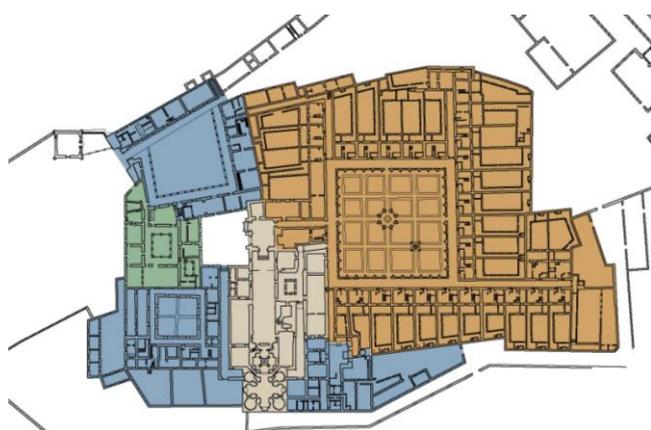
Plano de planta levantado por el arquitecto Pedro Muguruza en 1949
